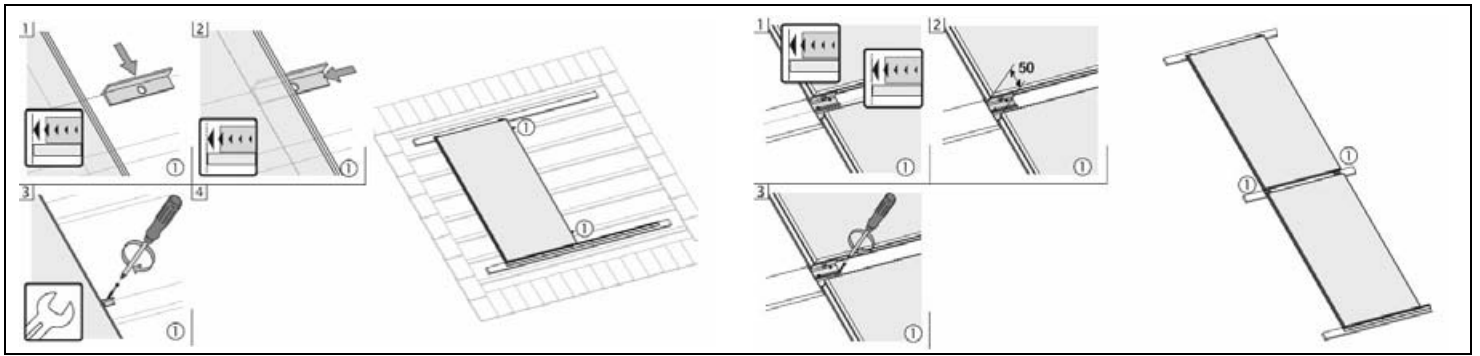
Maintien, entre chaque module, d'espaces constants horizontalement (à gauche, avec les entretoises) et verticalement (à droite, avec les pattes de fixation)
